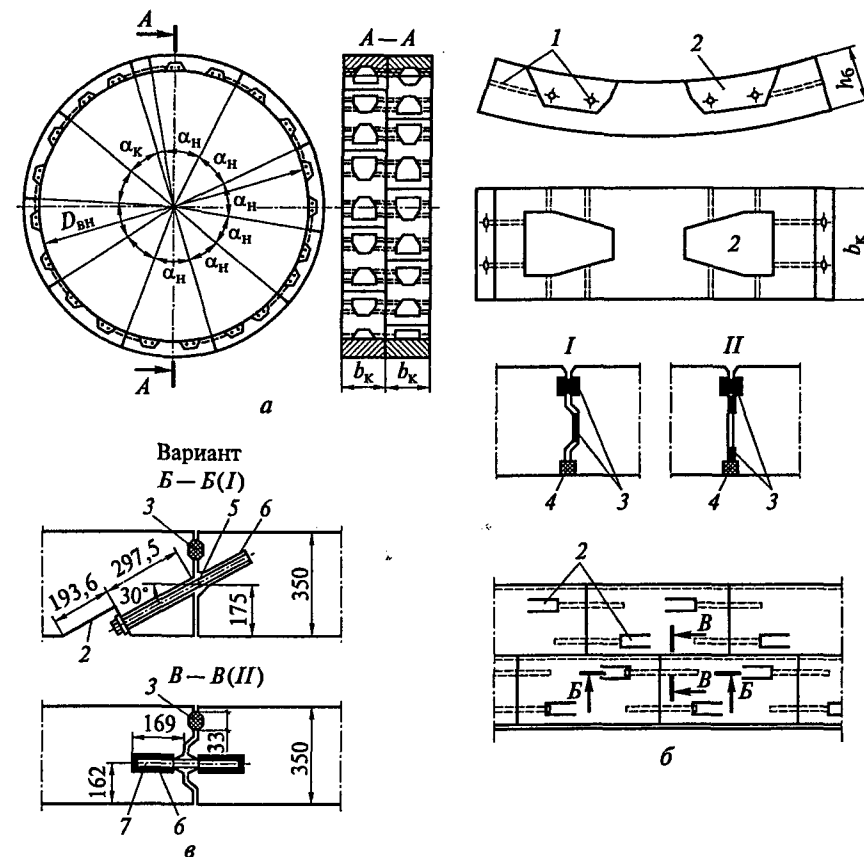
Обделка из железобетонных блоков (а) и конструкция блока (б, в): 1 — отверстия для болтов; 2 — местные углубления; 3 — неопределенные уплотнители; 4 — заполнение чеканочной канавки; 5 — шуруп; 6 — дюбель; 7 — шпилька; I — радиальный стык; II — кольцевой стык
